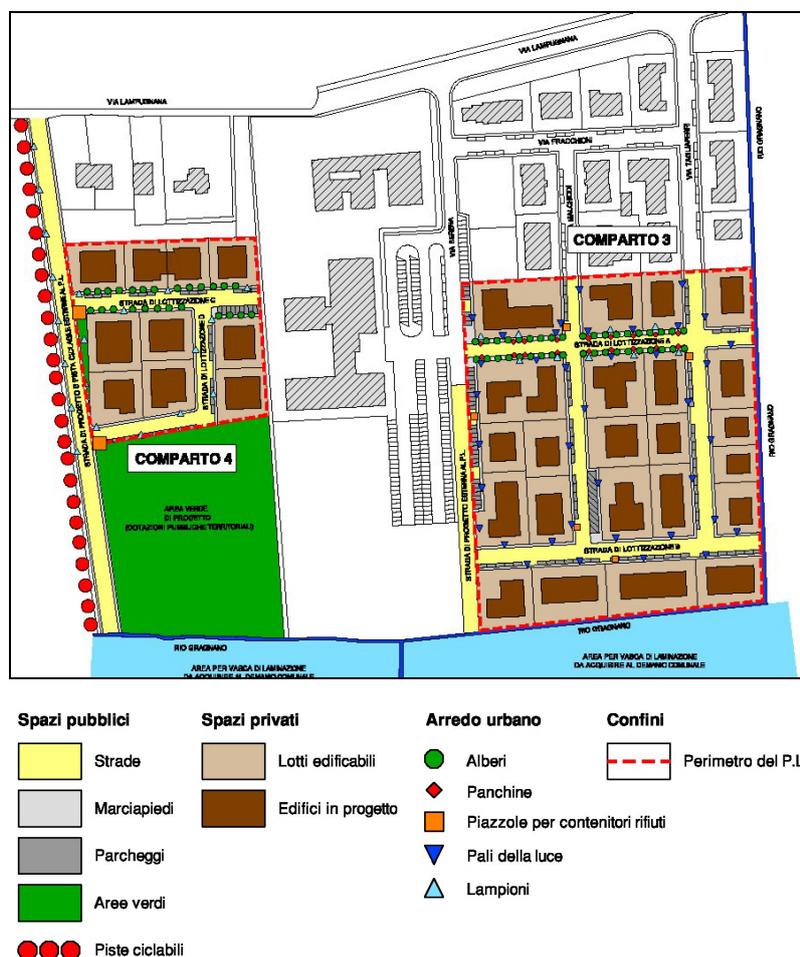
Planimetria di progetto del piano di lottizzazione (comparti 3 e 4)
